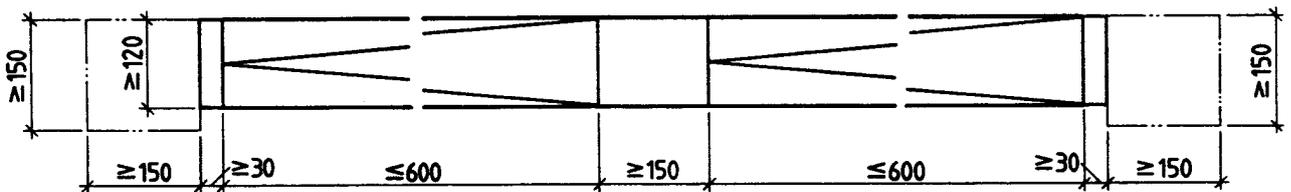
Rampe (Rampenlänge ≥ 600 cm)
